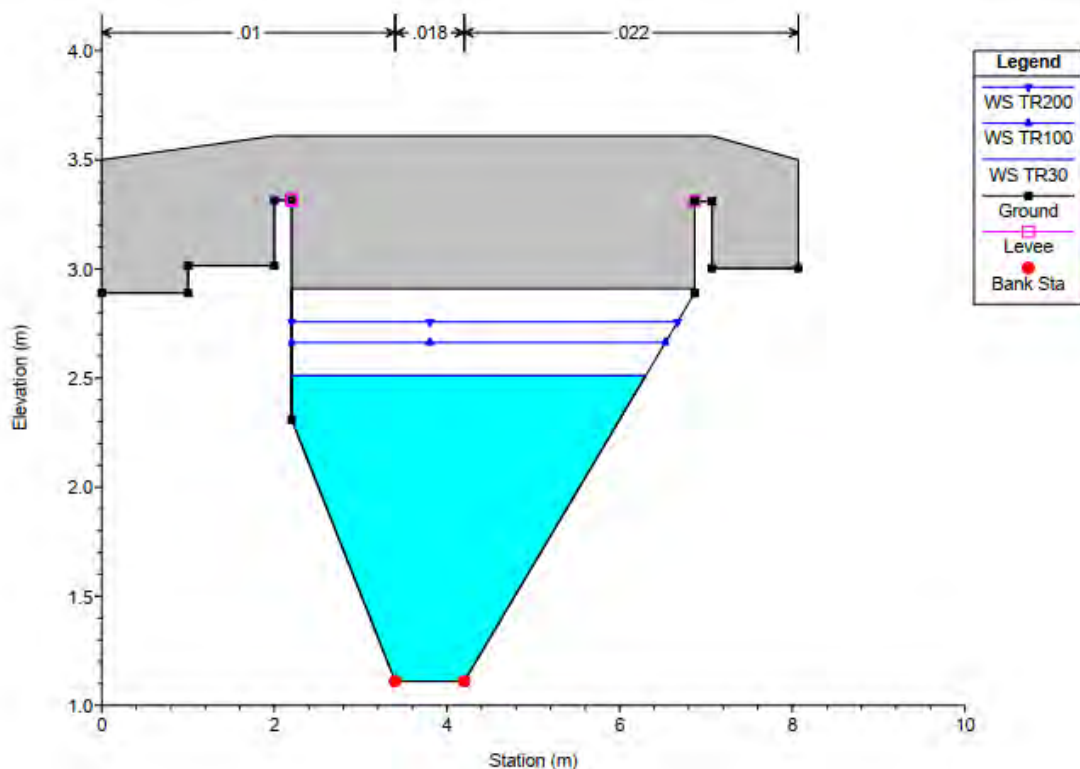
Sezione del ponte posto tra le sezioni 4 e 3
